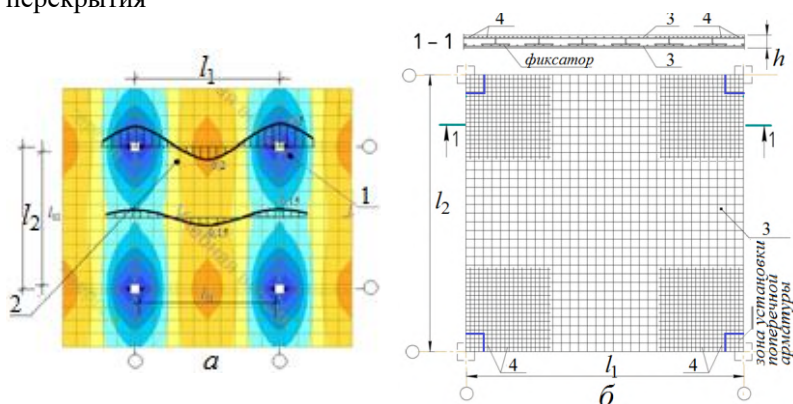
Надколонные (1) и пролетные(2) полосы плоской плиты перекрытия с коэффициентами распределения базового момента(а) и схема осовного (3) и дополнительного (4) армирования плиты (б)
